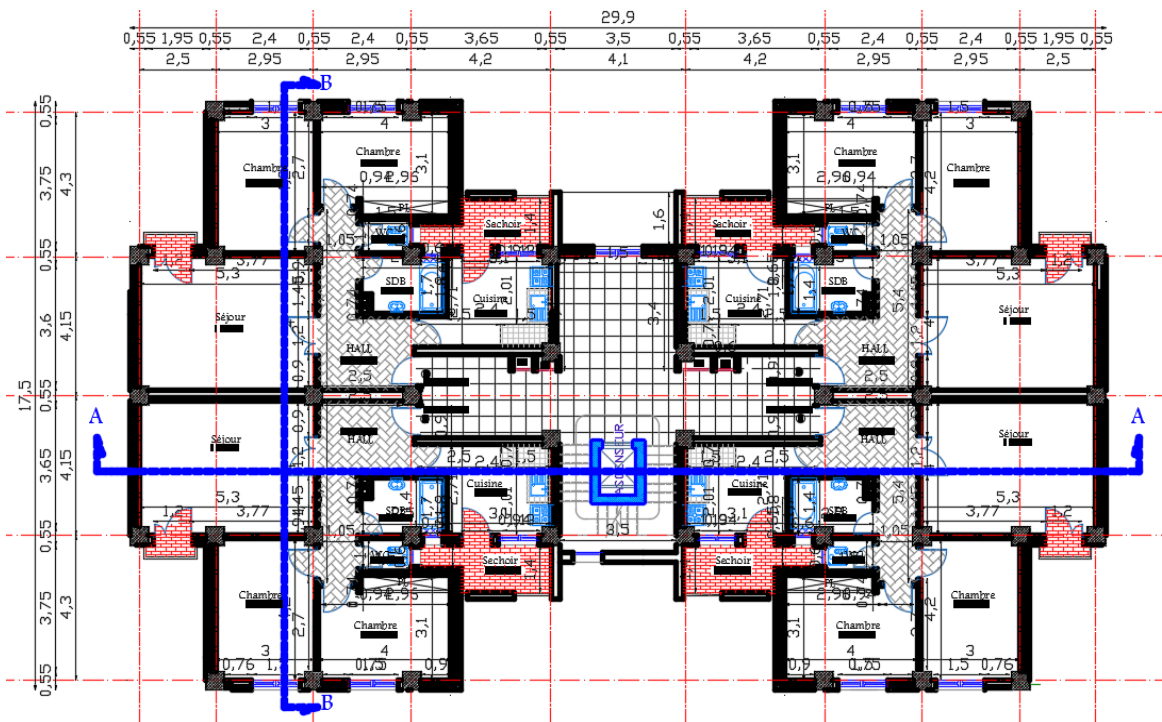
Plan de 1<sup>er</sup> au 2<sup>ème</sup> étage
